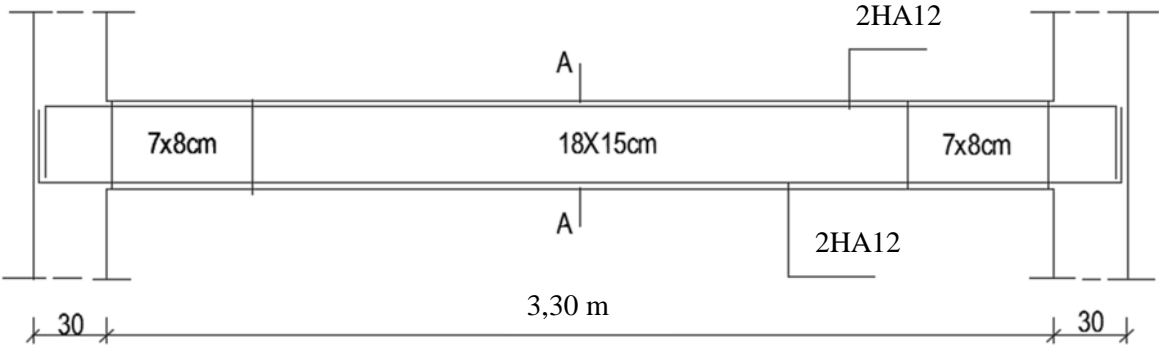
Détails du ferrailage de la poutre de chaînage.
